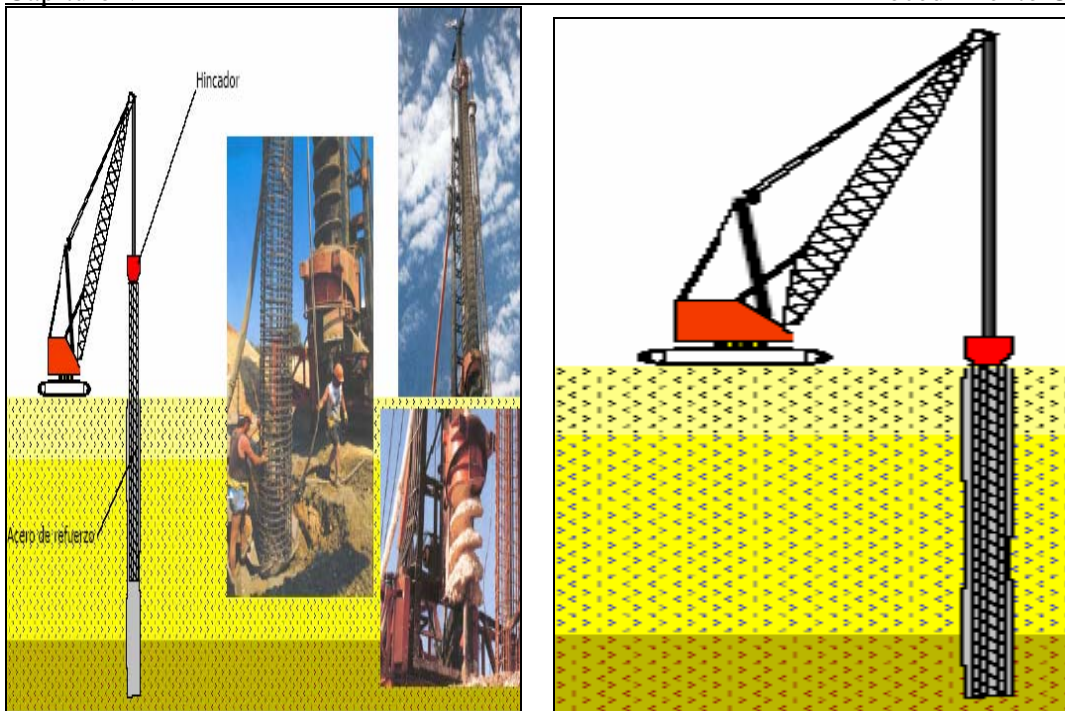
Colocación del Acero de Refuerzo (opcional)
